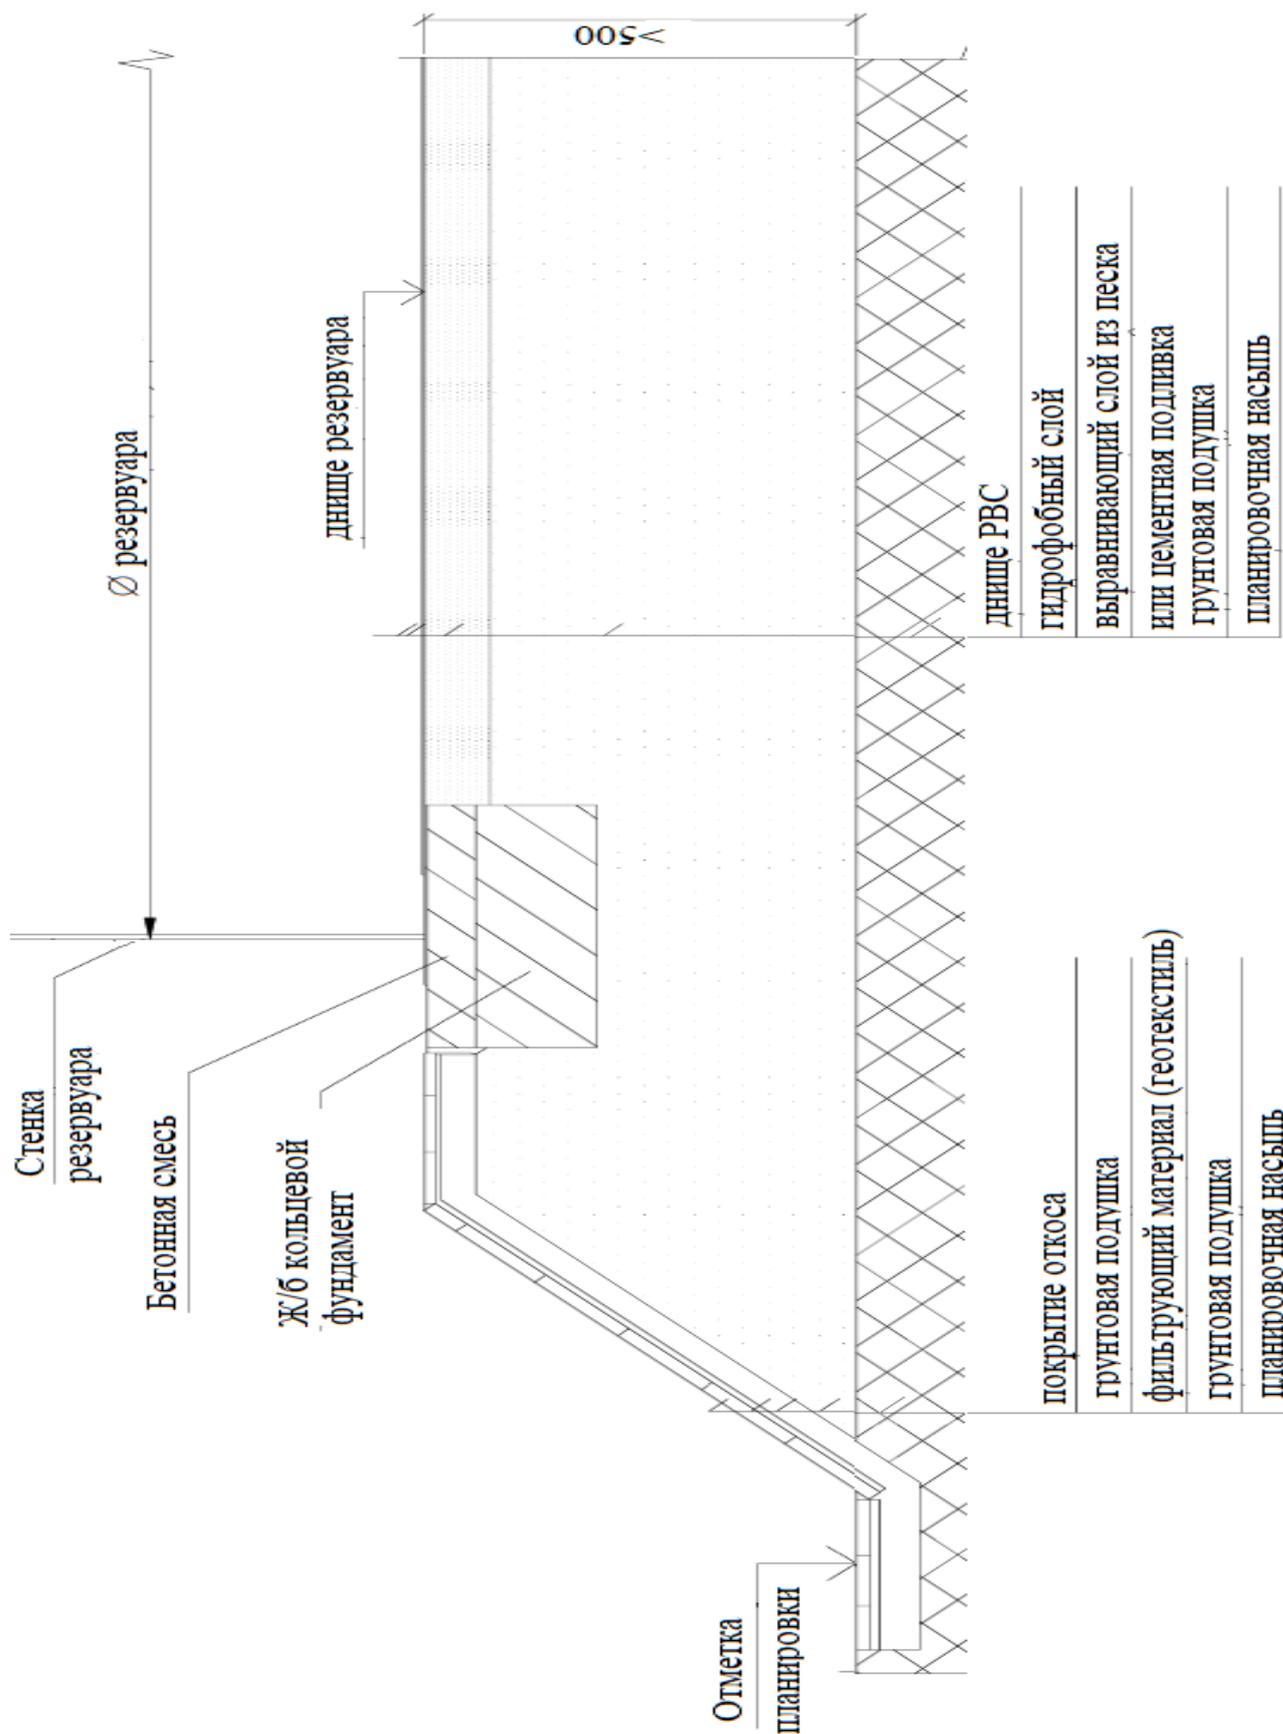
Схема фундамента резервуара после устранения просадки.
